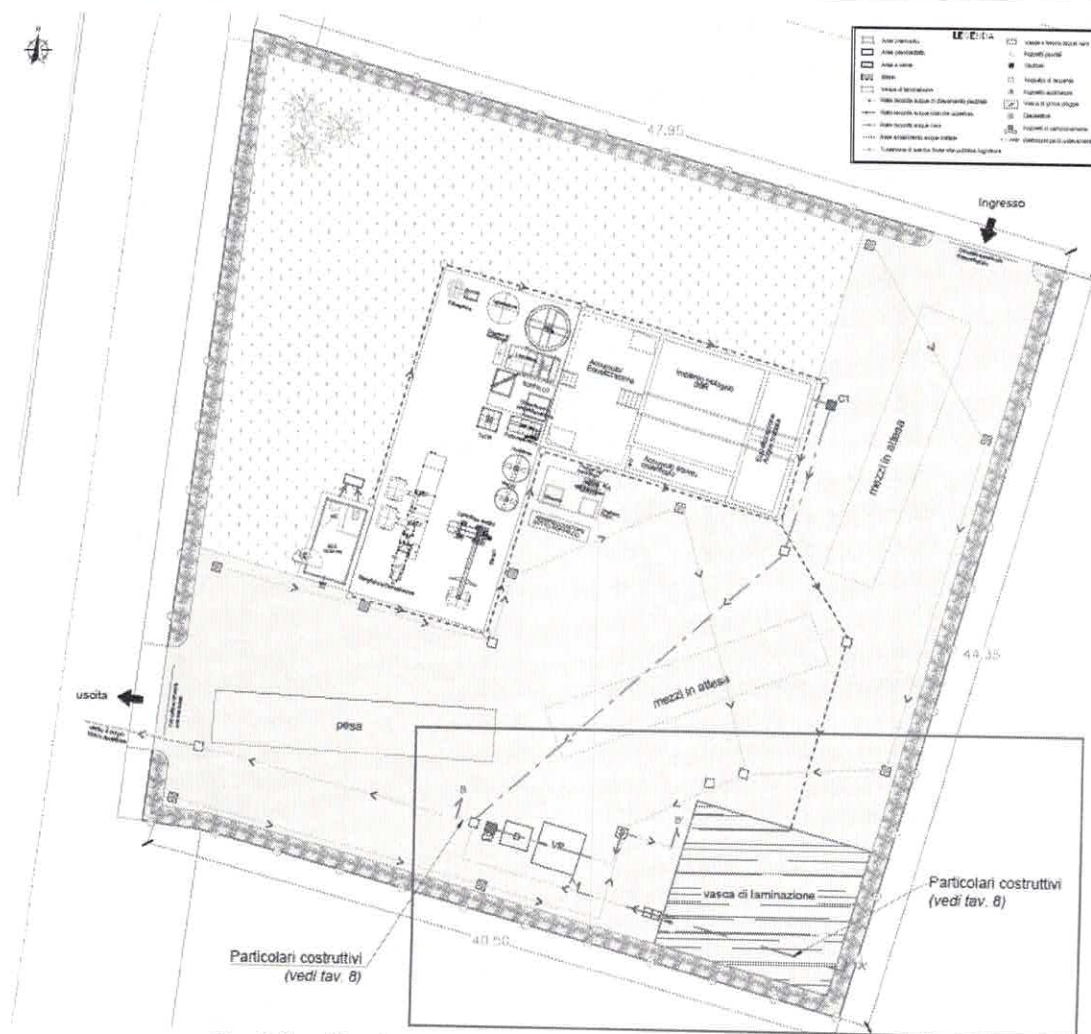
Planimetria gestione acque (stralcio Tav. 5 rev. 1)
